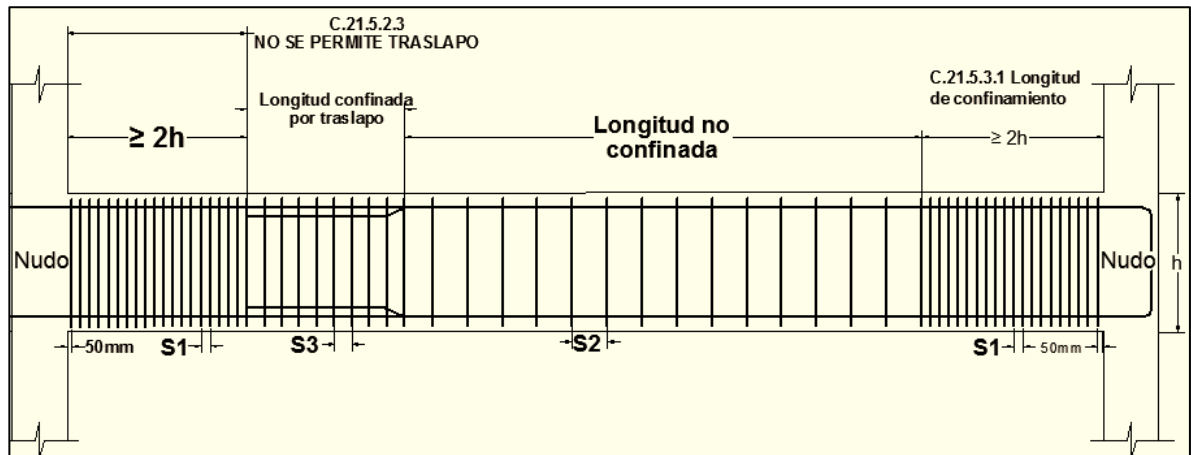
Separación del refuerzo transversal en las zonas de la viga.
